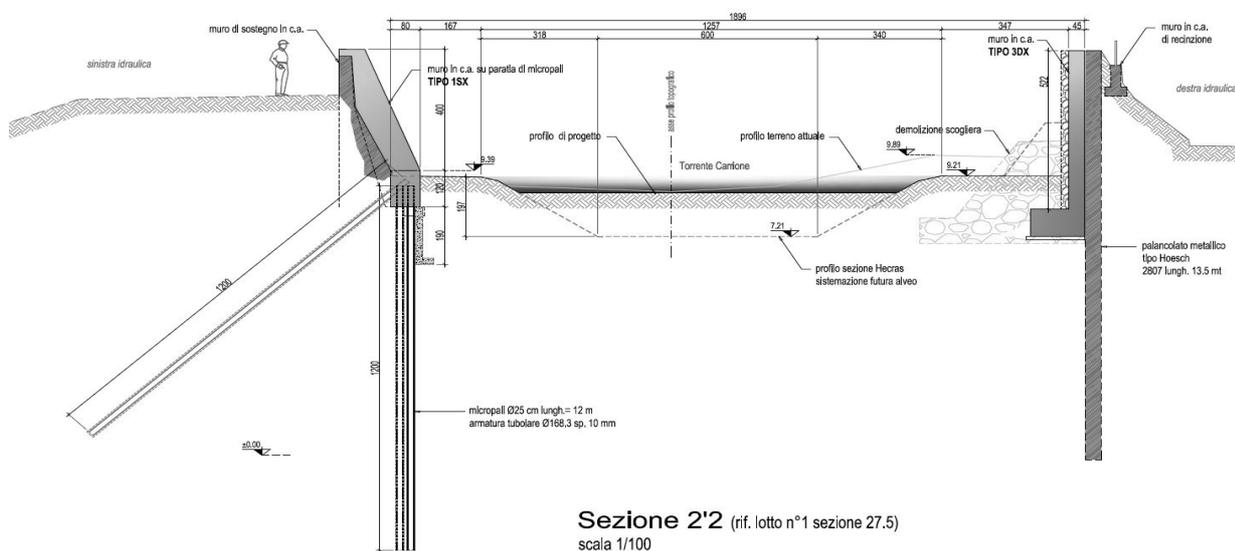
soluzione progettuale adottata nella sezione 27.5
